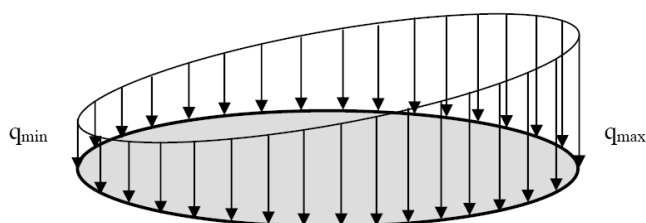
Расчетная вертикальная нагрузка на фундамент
